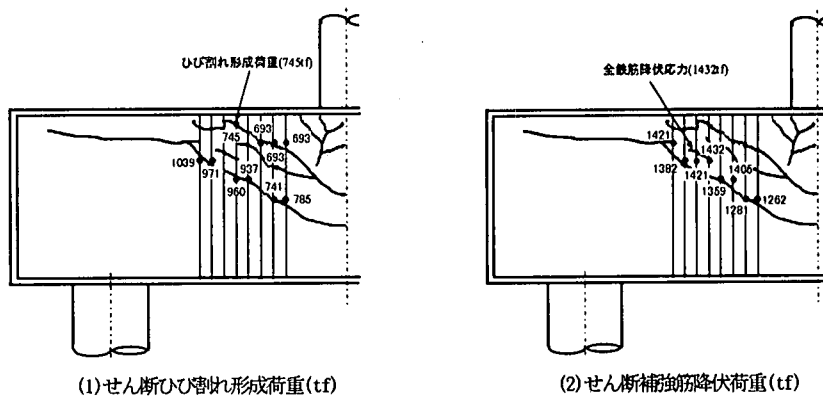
試験体No. 2のひび割れ、せん断補強筋降伏の進展の様子
